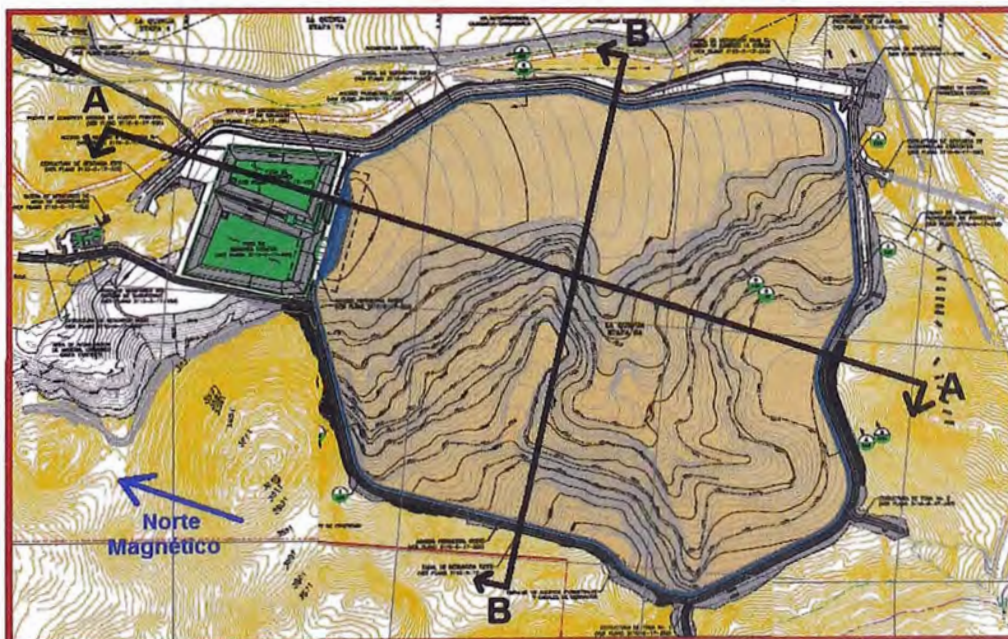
Plano en planta de la Plataforma de Lixiviación
